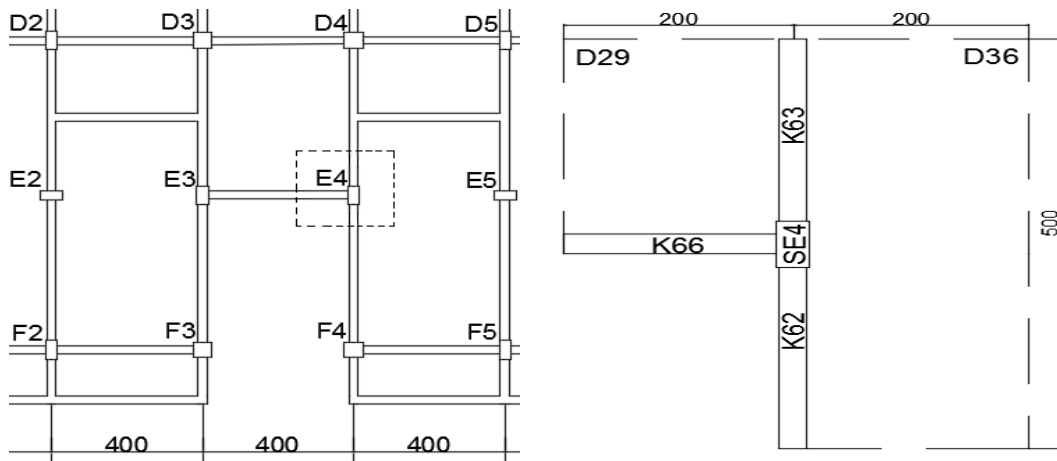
Plan 4 B2 kolonunun Plan 4'deki yük dağılımı ve kalıp planındaki yeri.
